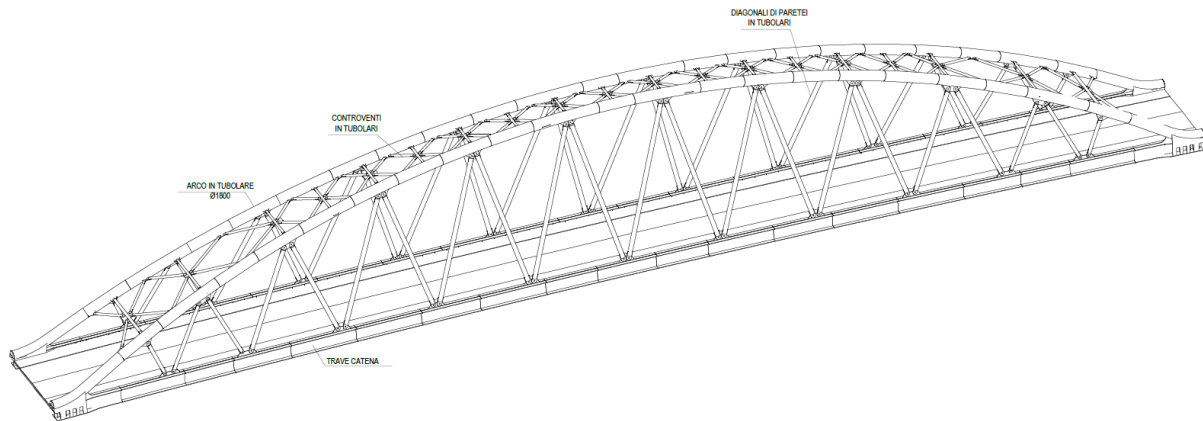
Vista assonometrica del ponte (estratto tavola 24V25_PF_T_ST_702_r00)
